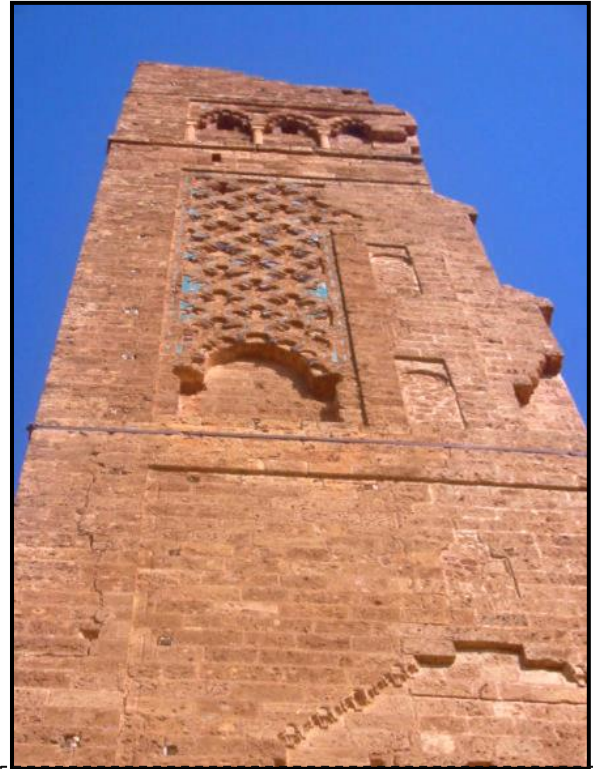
AVANT RESTAURATION DE 2010, ELEVATION LATÉRALE DROITE
